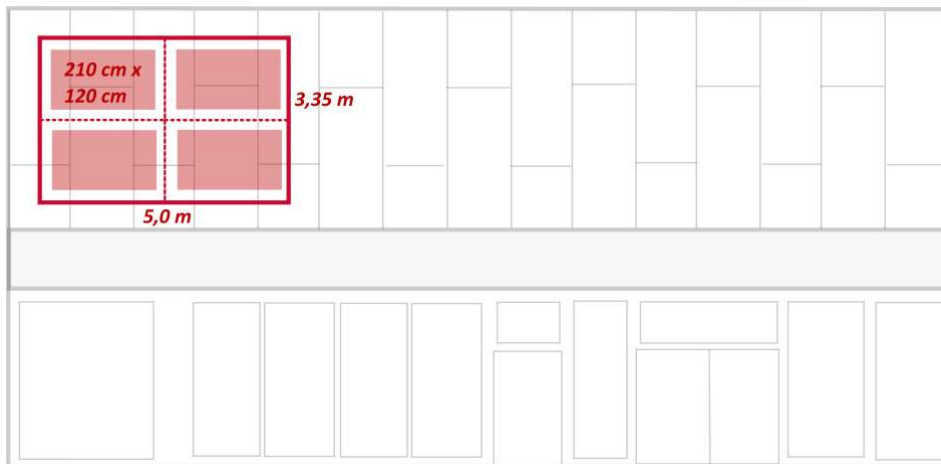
Sammелwerbeanlage Südwest-Fassade, Gebäudeteil T32
